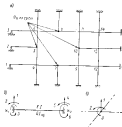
Схема перекрестия в виде системы перекрестных базис.
